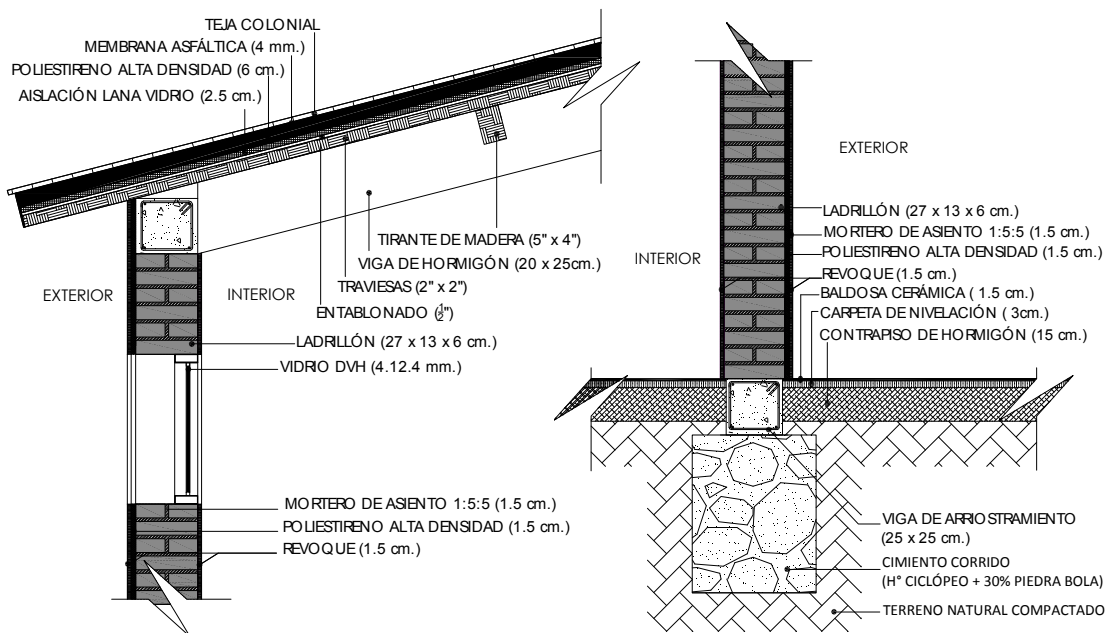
Detalle del sistema constructivo para cubierta y muro con mejoras propuestas.
